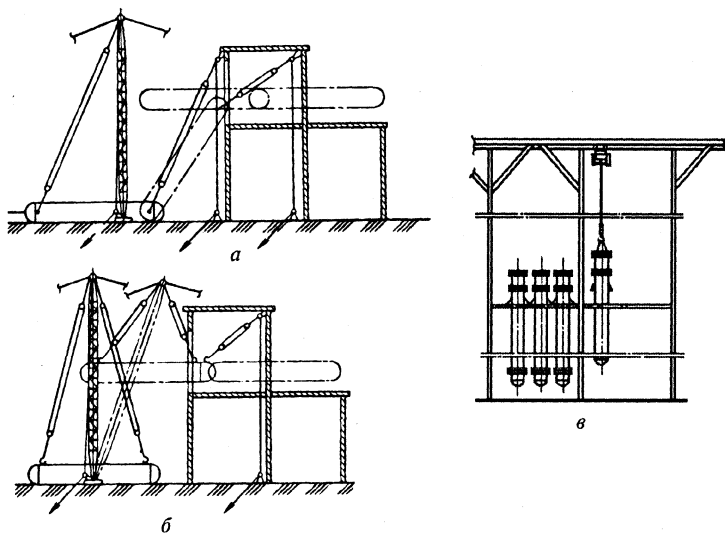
Схемы монтажа теплообменных аппаратов под перекрытием
